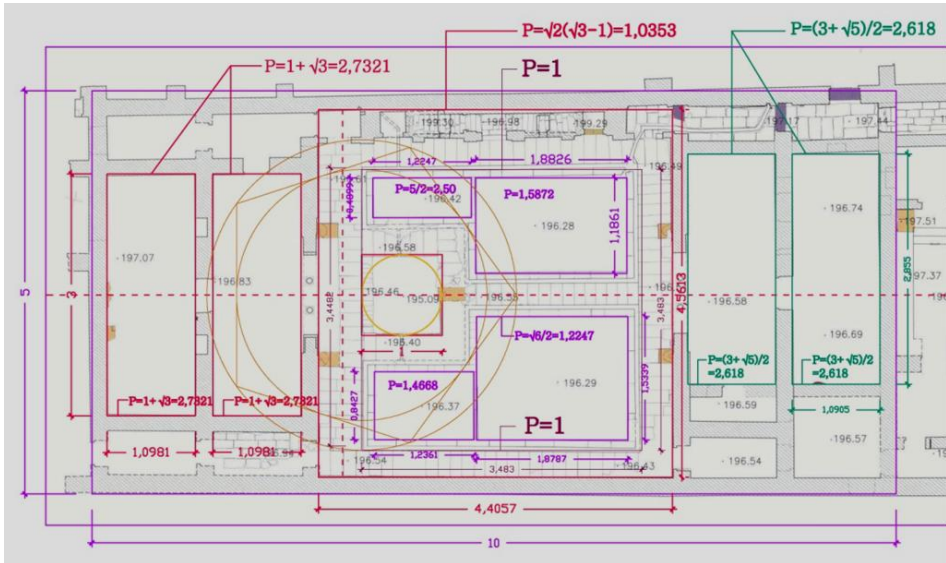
Casa de la Alberca. (FUENTE: Planimetría del arquitecto Pau Soler Serratos).
